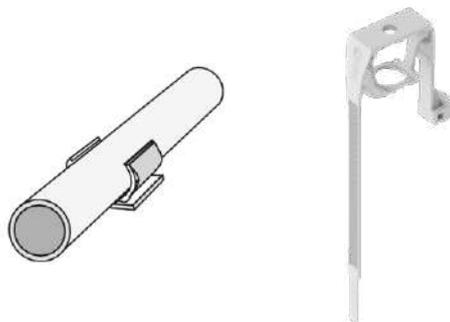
Fixação de instalações aparente: abraçadeira e suporte para tubos
